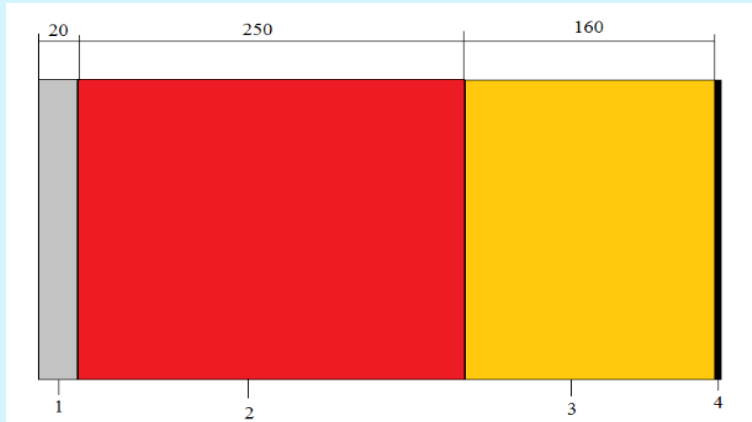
Состав наружной стены: 1-цементно-песчаная штукатурка, 2-кирпичная кладка, 3-минераловатный утеплитель, 4-наружное покрытие.
